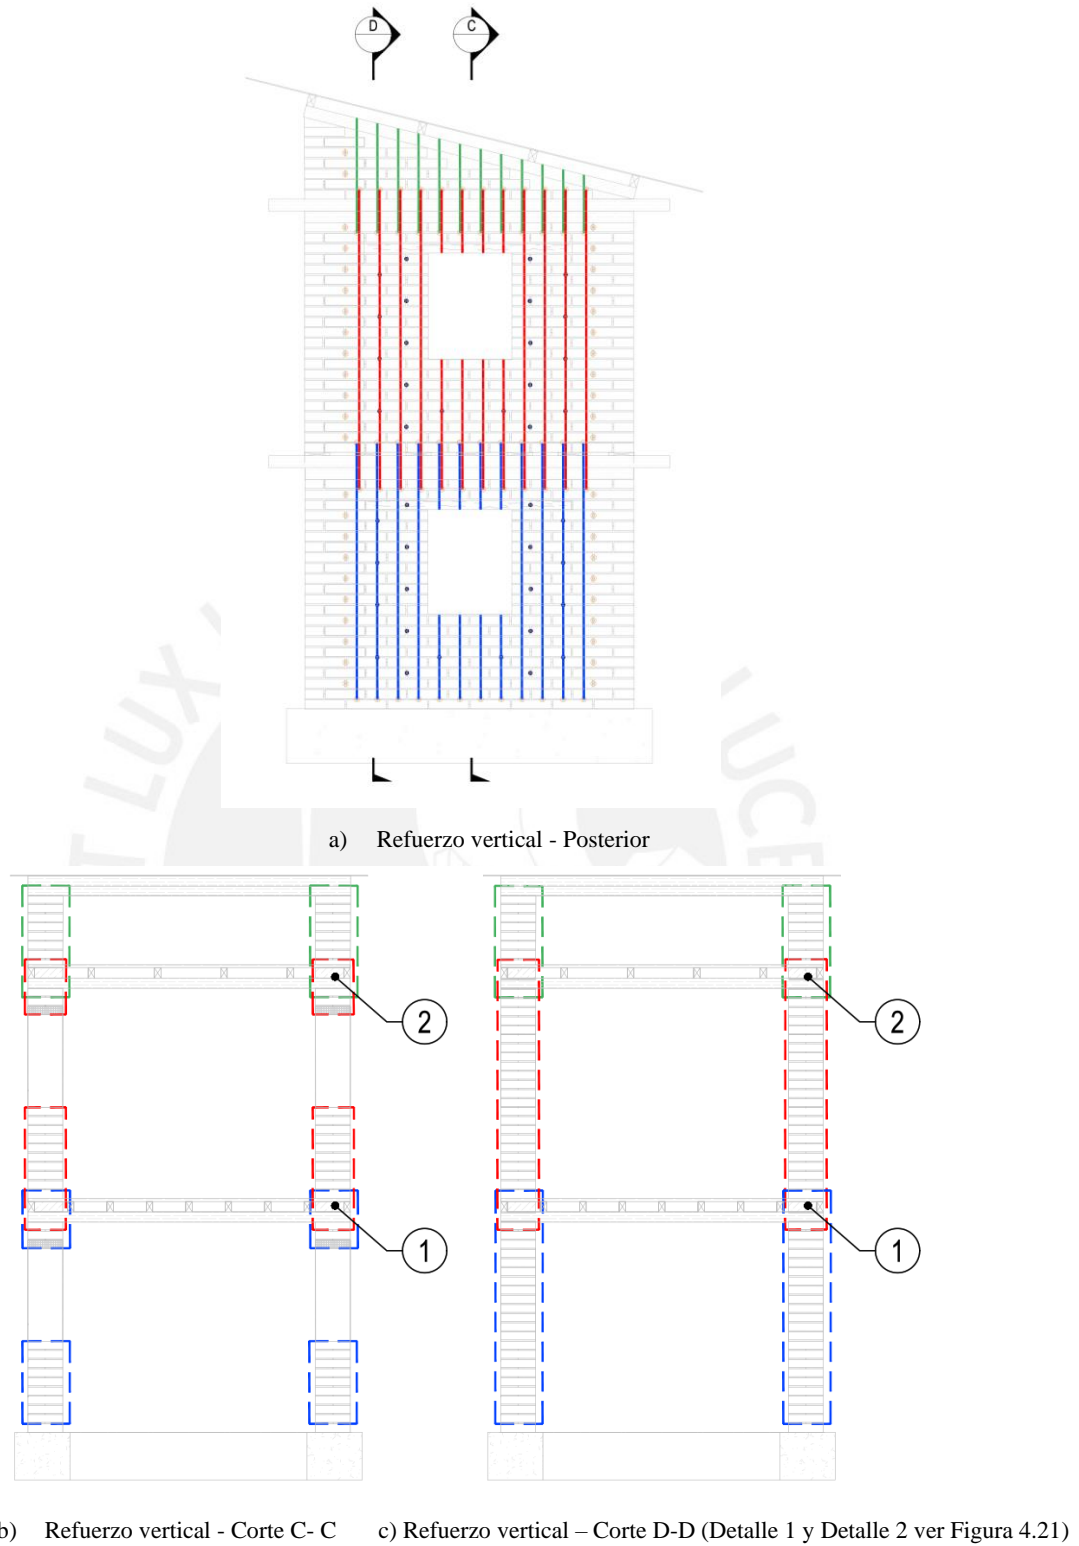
Refuerzo vertical en el muro posterior / Conexión del refuerzo entre el primer piso, segundo piso y techo
